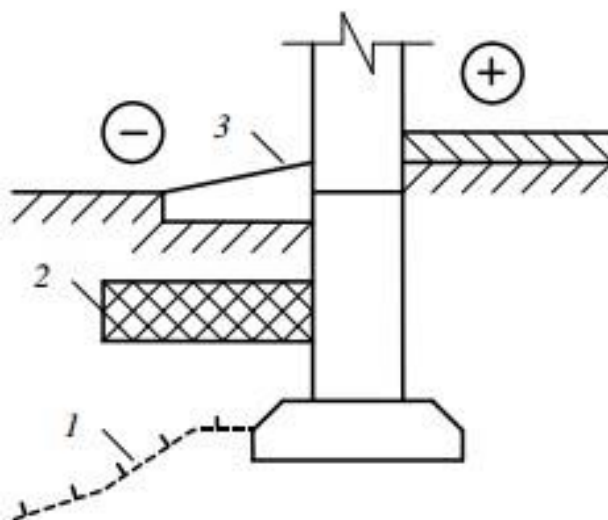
Теплова ізоляція ґрунту біля фундаменту:
